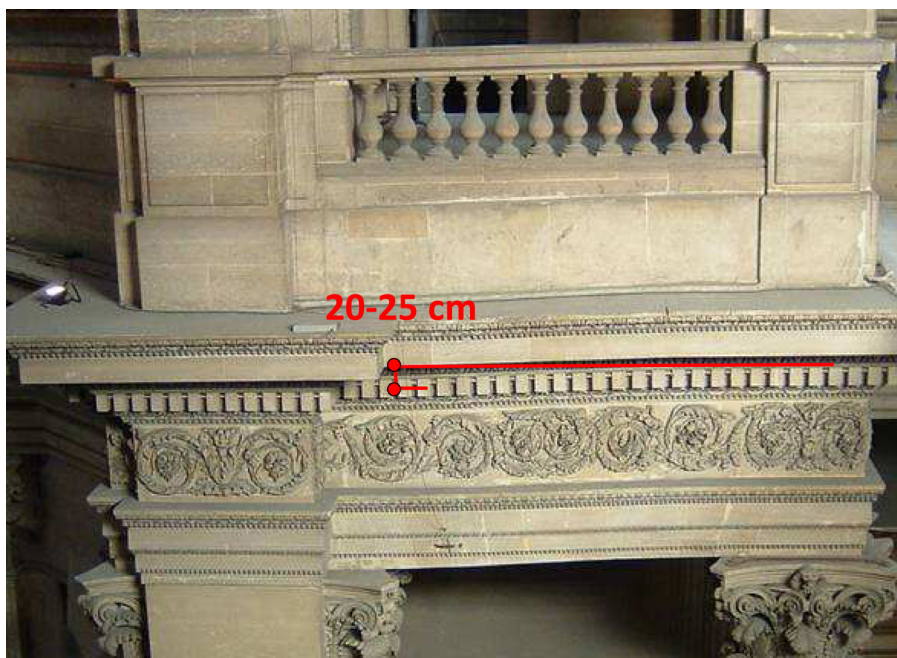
L'evidente cedimento subito dalla sommità dei pilastri.
